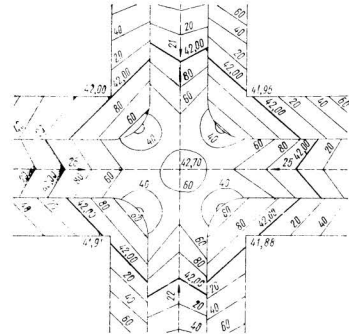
Вертикальная планировка перекрестка, расположенного в котловине.
